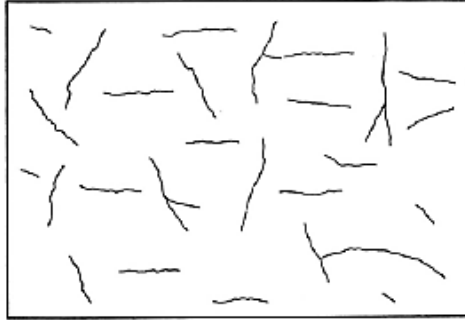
Grieta por retracción plástica en una losa
